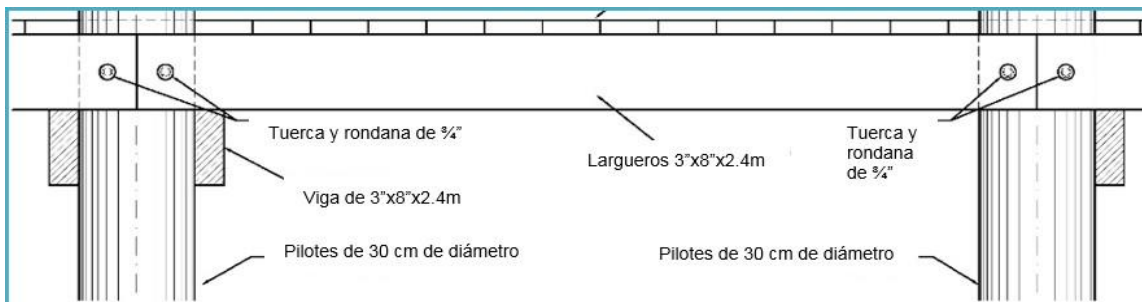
Detalle de la cubierta de madera del muelle.
